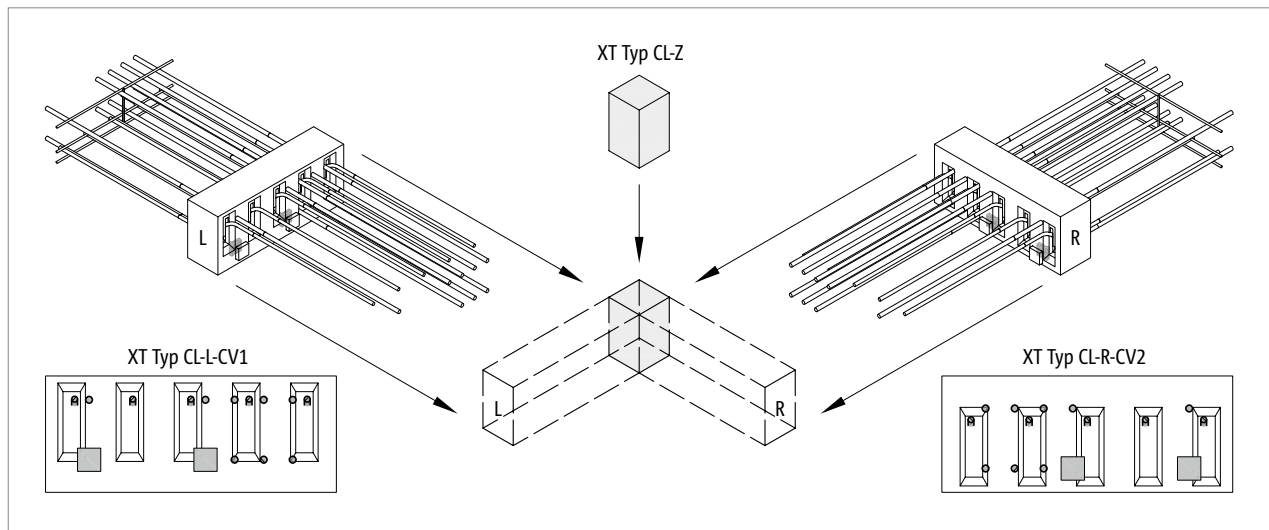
Schöck Isokorb® XT Typ CL-L-CV1, XT Typ CL-R-CV2: Anordnung an der Ecke mit Eckdämmkörper
